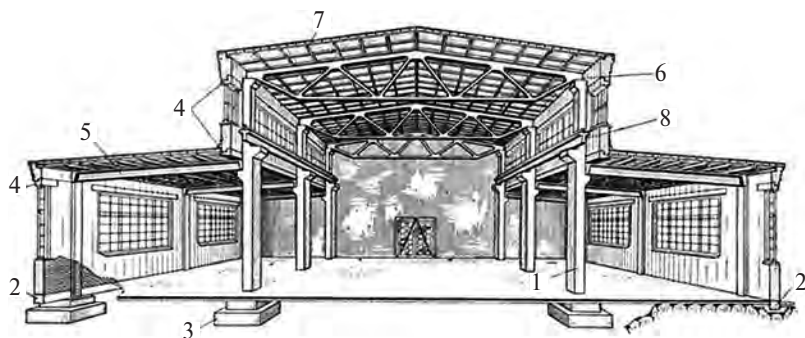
Одноэтажное каркасное промышленное здание горно-обогатительного комплекса с железобетонным каркасом:
